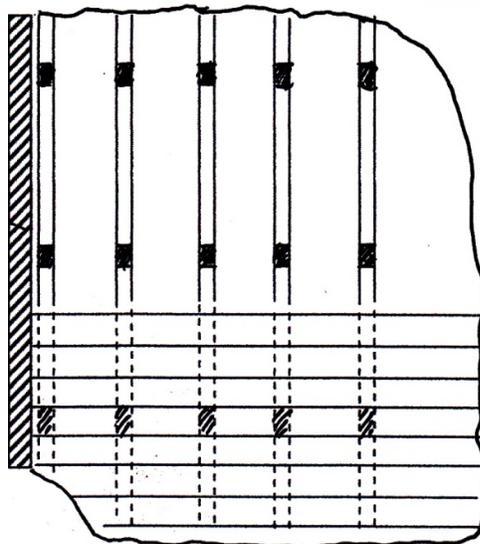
Detail sambungan precast deck dan kayu laminasi atas.
